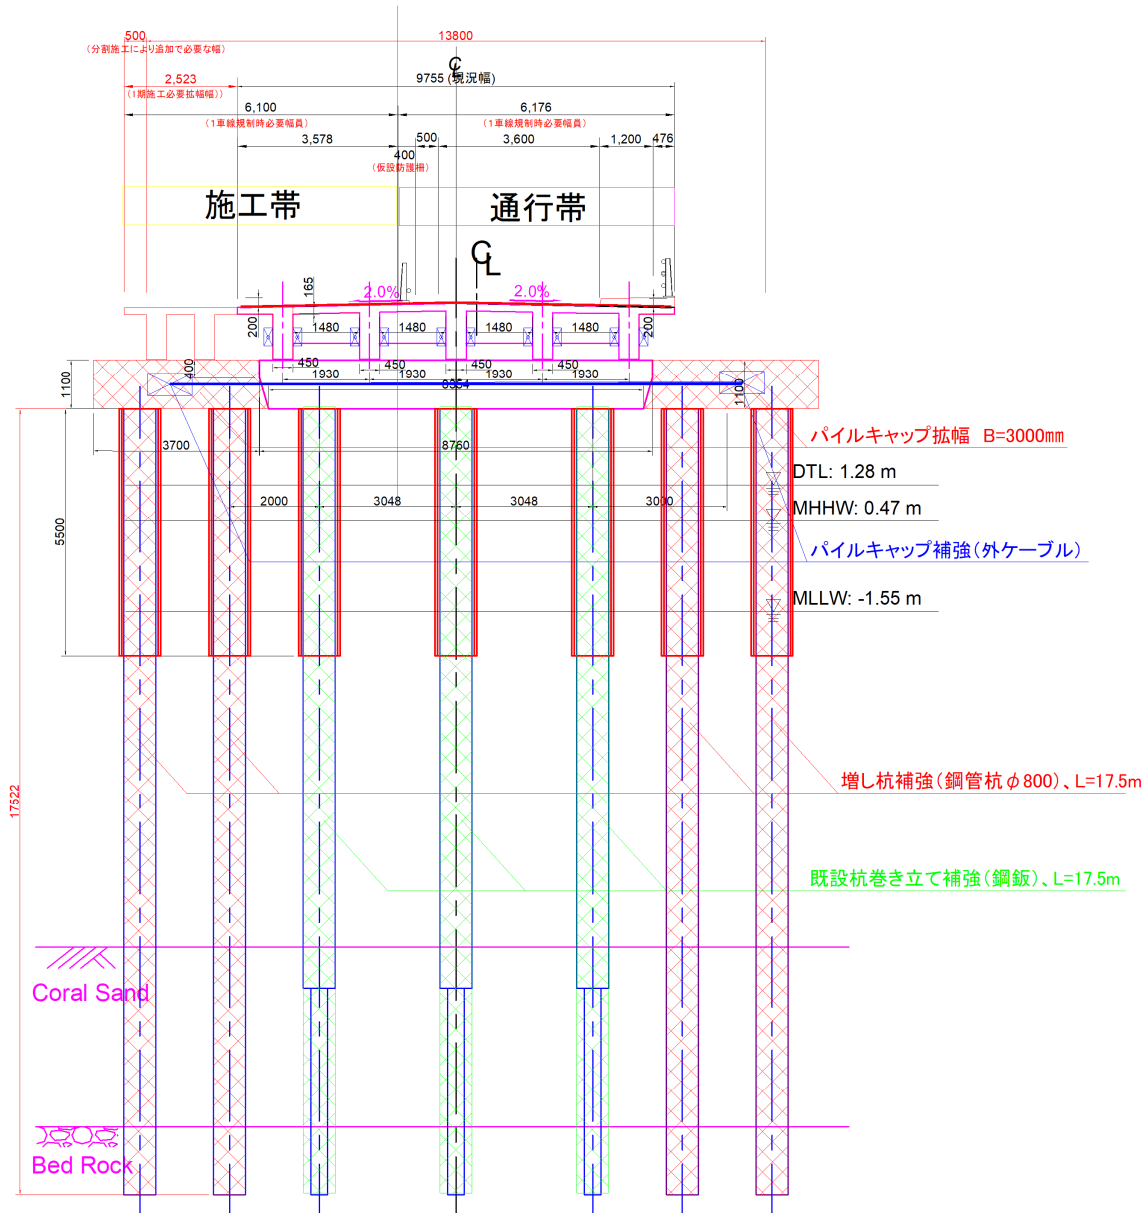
既設橋の補強構造断面図(迂回路なしの場合: STEP1)
